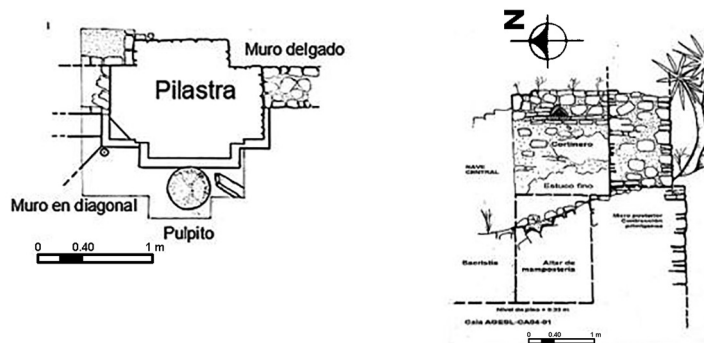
Pulpito adosado a la pared norte y detalles del muro sur del altar de mampostería o presbiterio (P. Morales 2019).
